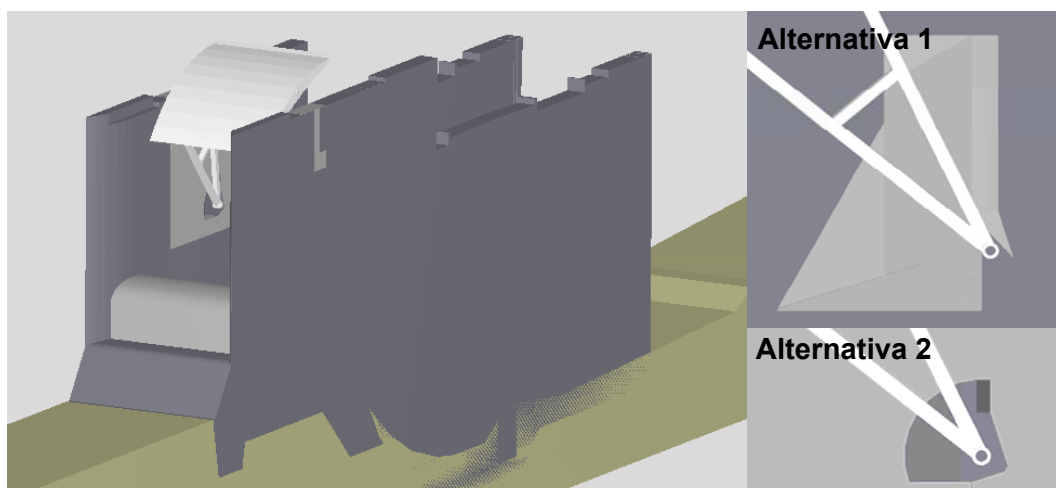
Vista tridimensional de la geometría modelada y detalle del muñón
